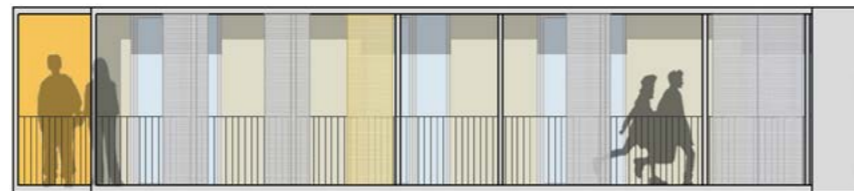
Estratto prospetto Ovest:serra con funzione di ballatoio.
